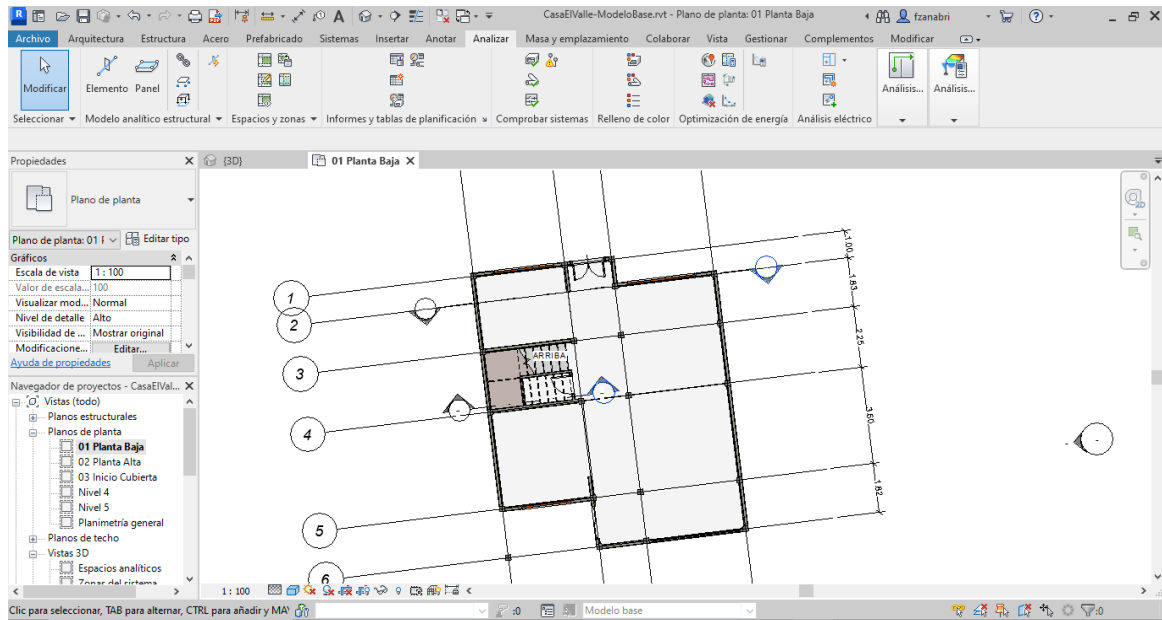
Dibujo de Planta Baja en Revit de Autodesk
